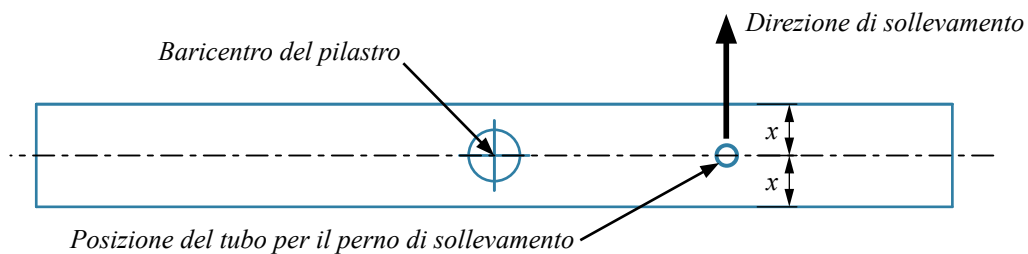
Posizione di installazione del tubo per il perno di sollevamento.
